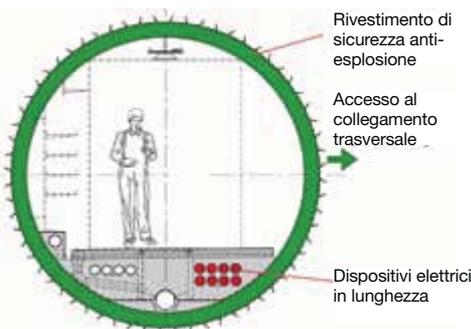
Sezione trasversale del tunnel Milchbuck e delle estensioni realizzate (galleria di sicurezza e collegamenti).
